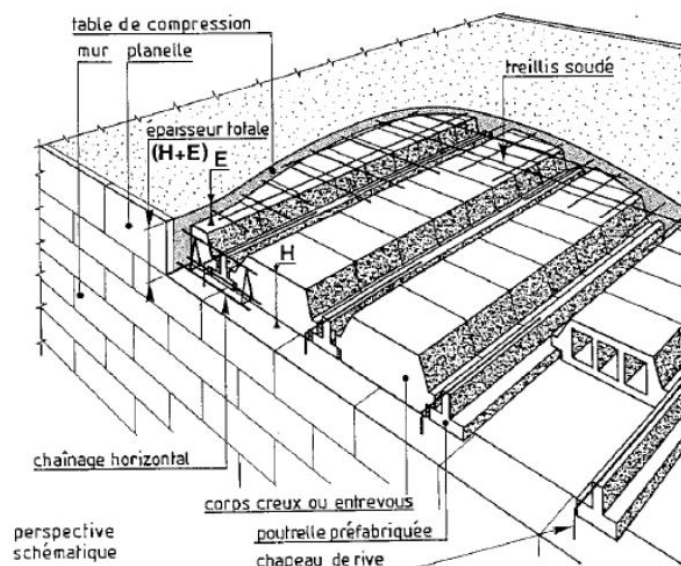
les éléments principaux d'un plancher à corps creux. [2]
